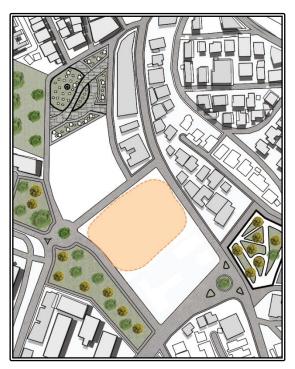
Plan délimitant le terrain de l'intervention architecturale Traitée par l'auteur
